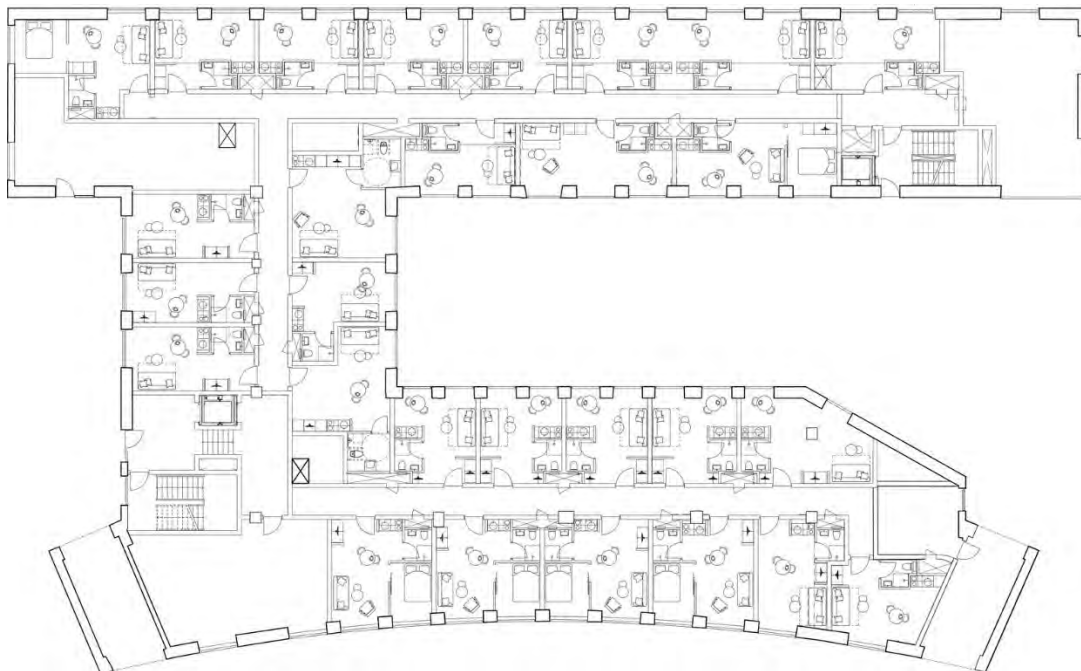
Планувальна структура Youth Dwellings у Копенгагені: план типового поверху [4]
